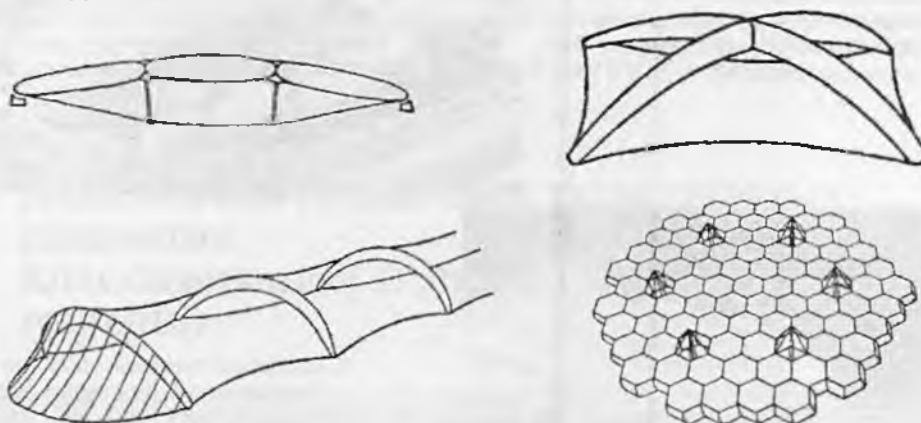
Комбинированные покрытия: а – пневмопанель, подкрепленная шпренгелем; б – арка с подвешенным тентом; в – многопролетное здание с несущими арками, тентовой оболочкой и вантовыми оттяжками; г – плита из пневмоподушек, подвешенная к стойкам
